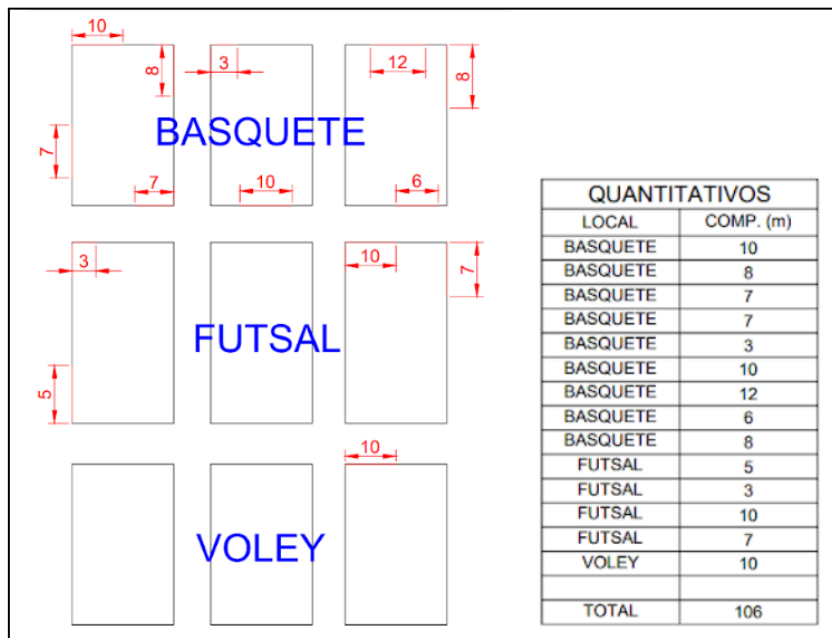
Levantamento das canaletas a serem reconstruídas.
